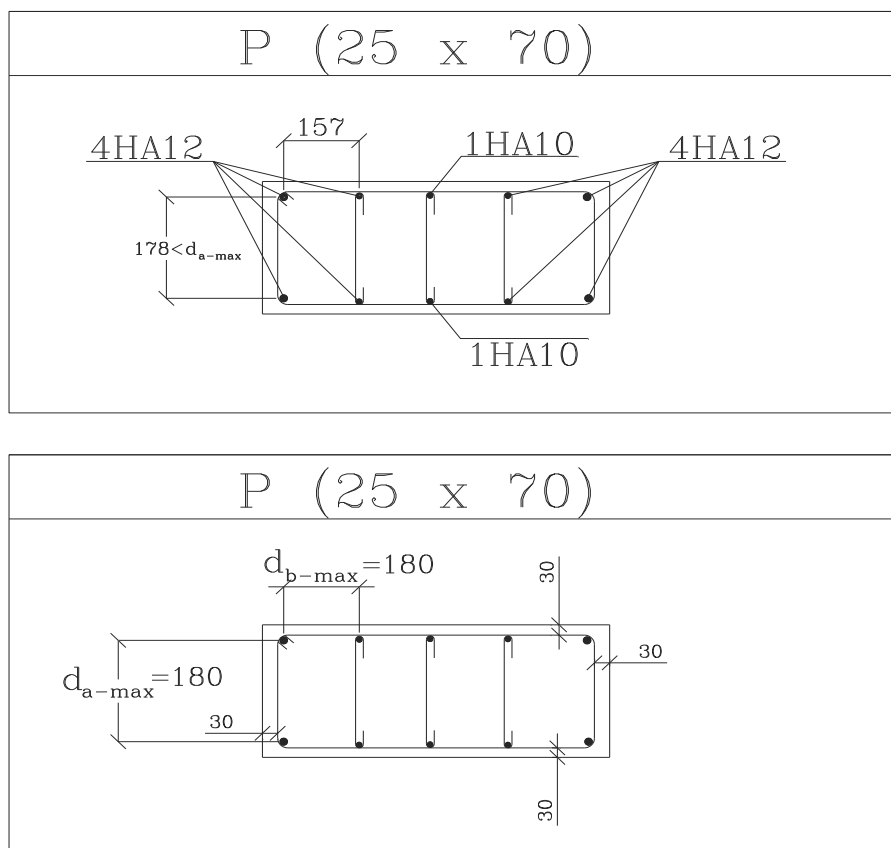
Schéma de ferrailage du poteau 25×70 à l'état minimal (Exemple 1)
